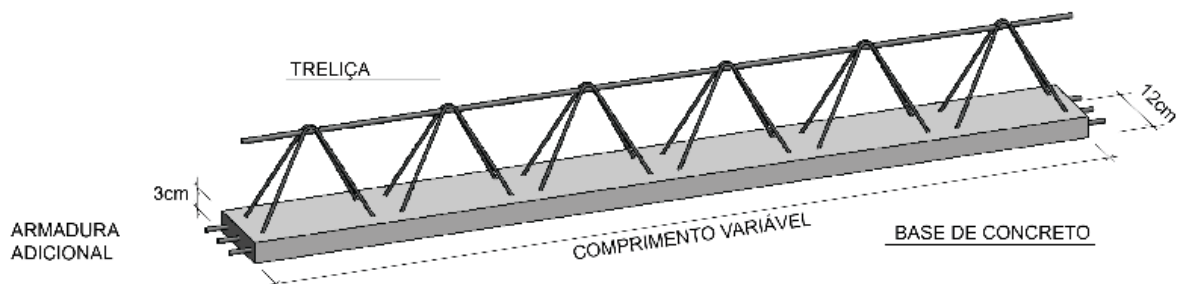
Vigota Treliçada (Lajes Hertel, 2018).
